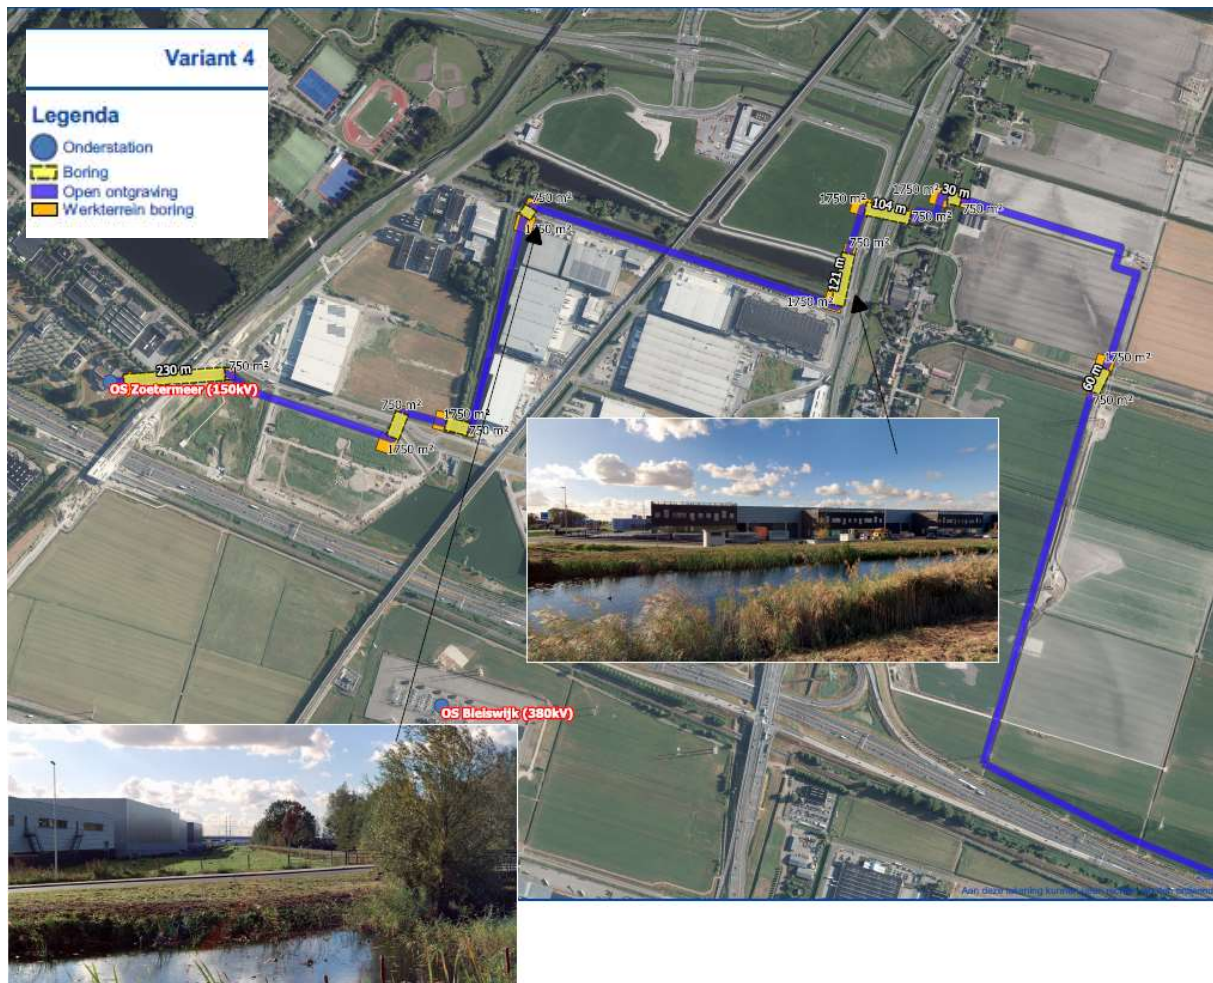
Weergave belemmeringen groenstrook tussen Plastoct en randstadrail
